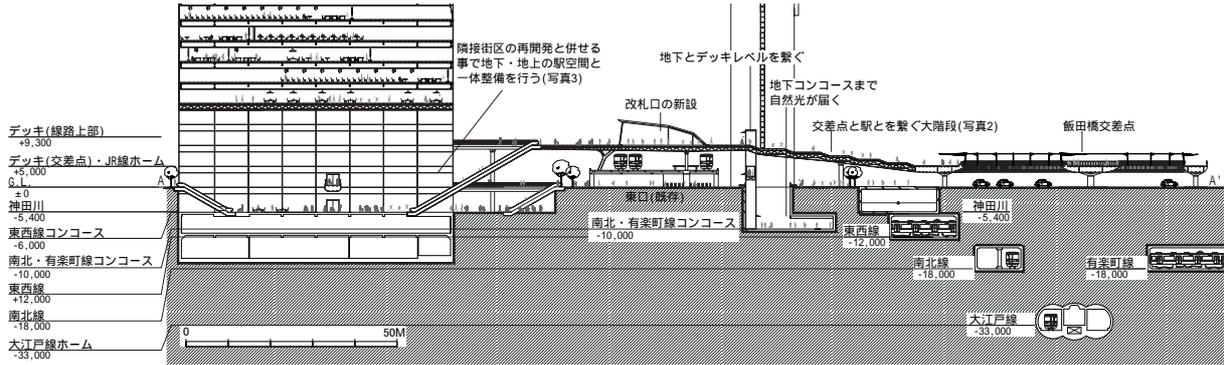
A-A' 断面図 (S=1/1800) (高さは階段の踏上と段数から算定)
